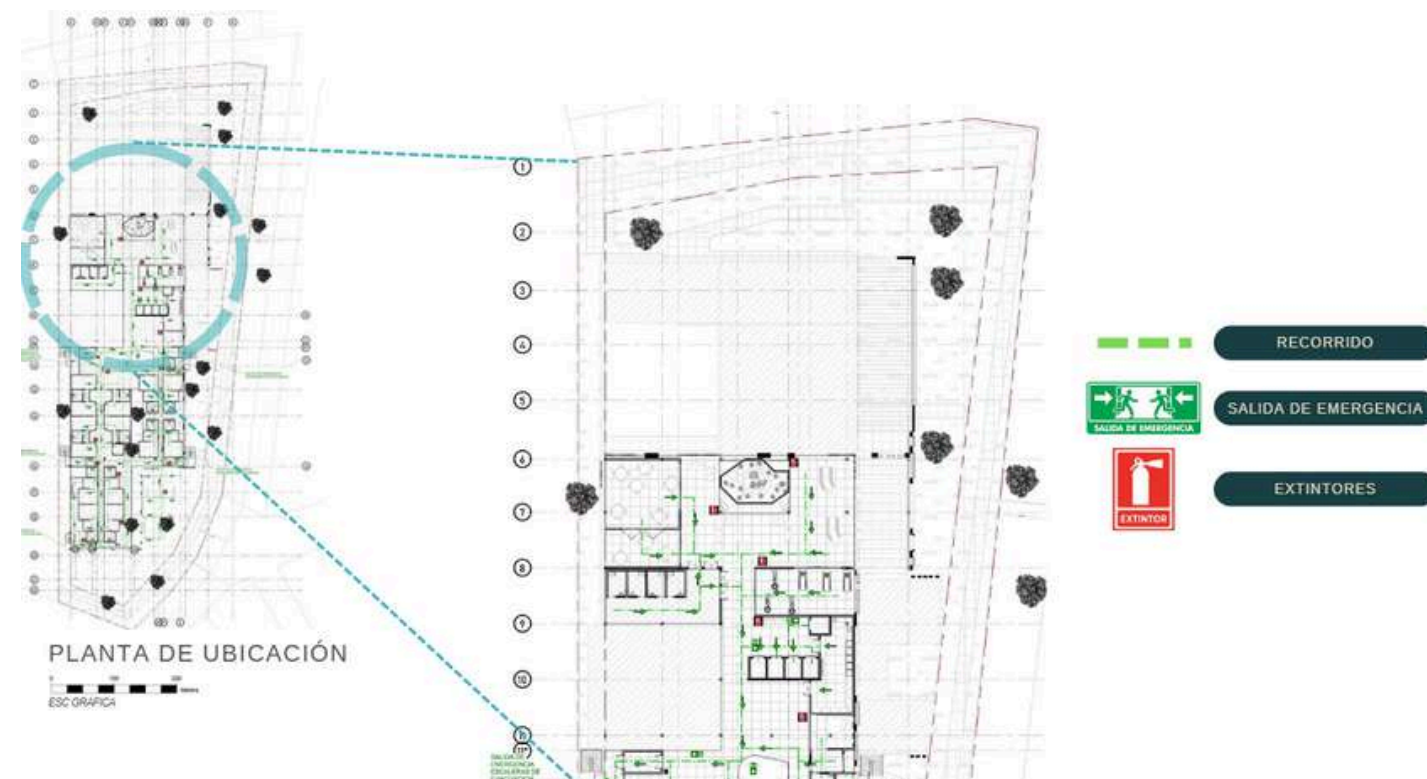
Planta Arquitectónica Evacuación Nivel 2.
